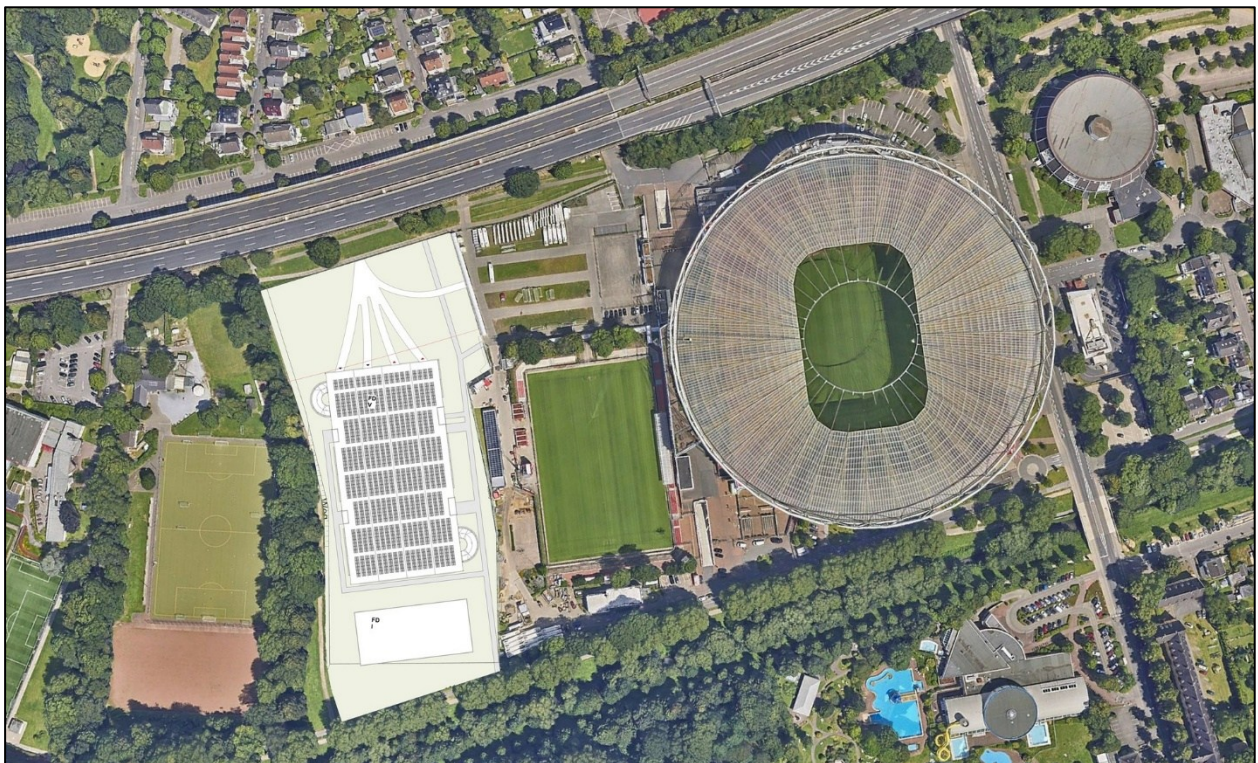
Planungskonzept – Lageplan für das Parkhaus [Quelle: syn architekten]
